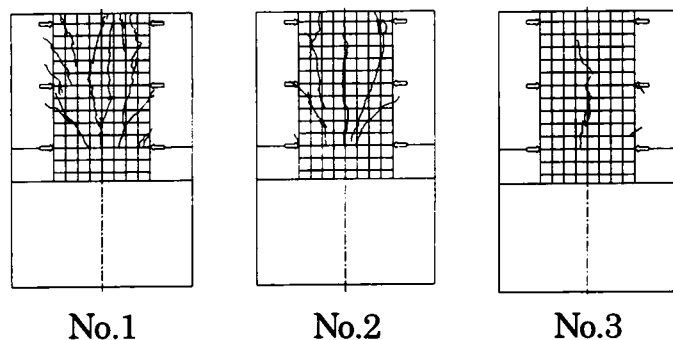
内筒鋼管のせん断降伏時における壁のひび割れ状況
